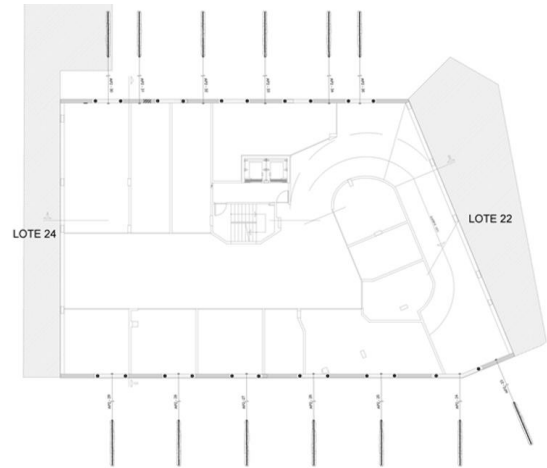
Ancoragens executadas no piso -2 (Geodrill, 2019)
